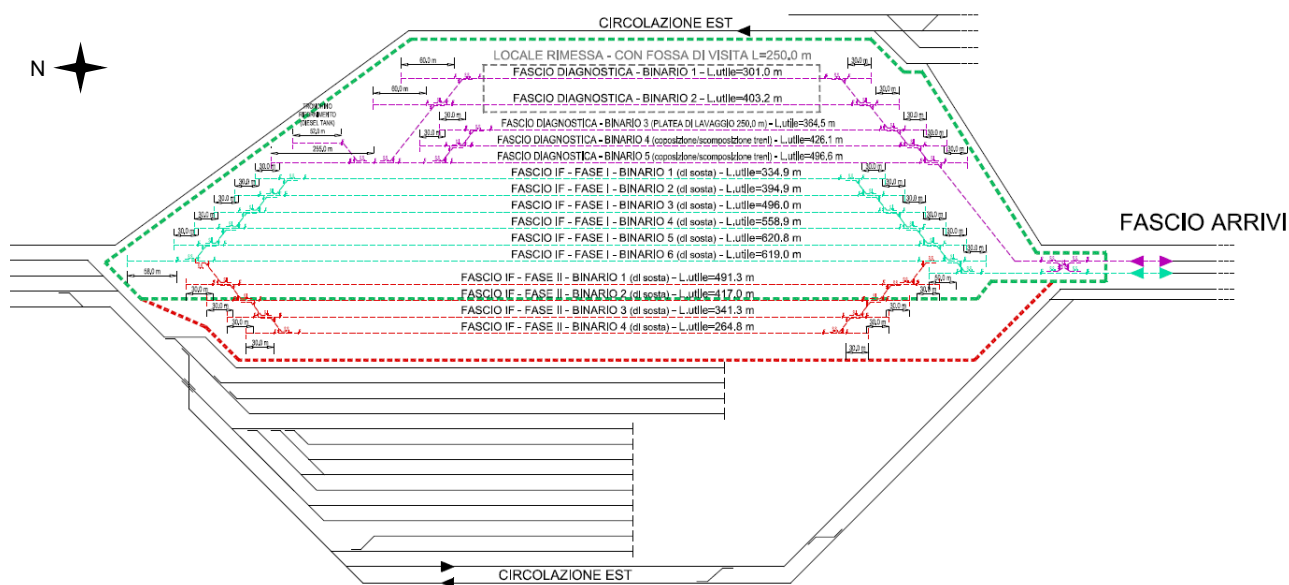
Piano schematico di stazione Nuovo Salario. Fonte "Roma Smistamento – Planimetria generale su ortofoto", allegato alla Lista di controllo.
